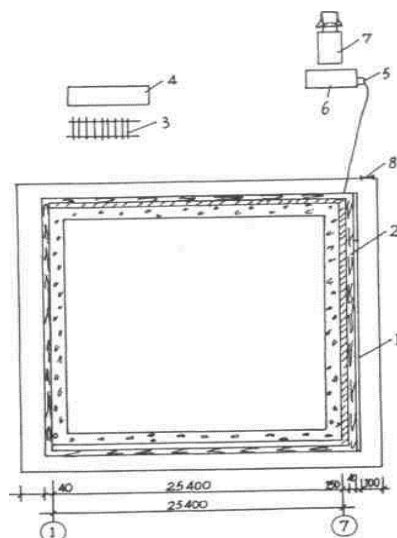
Общая схема организации работ по усилению фундаментов здания:
